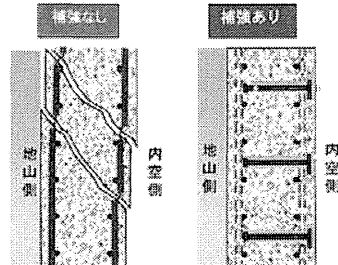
鉄筋コンクリート増打ち工法の施工例
